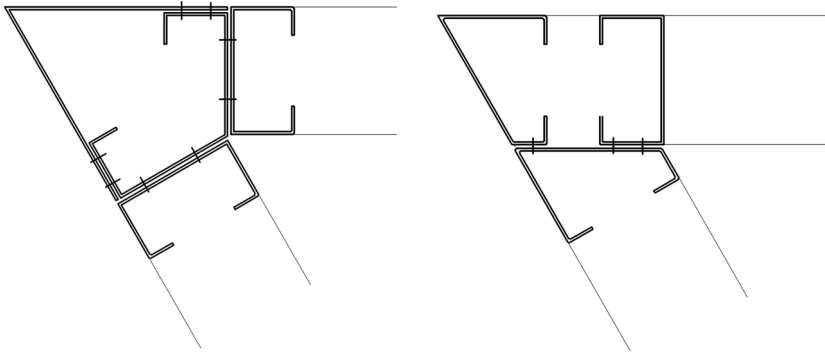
Açılı plan geometrisinde, kirişlemelerin, duvar bağlantısı. [67]
